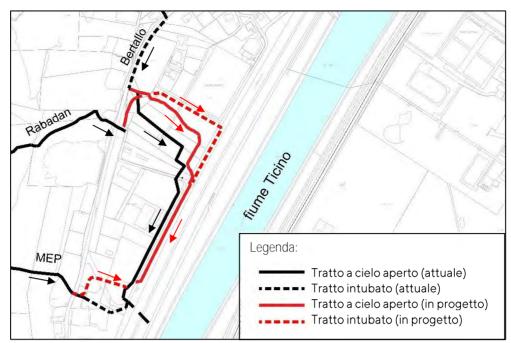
Estratto planimetrico su base catastale in corrispondenza dei tracciati dei riali Bertallo, Rabadan e MEP (situazione attuale e in progetto).
